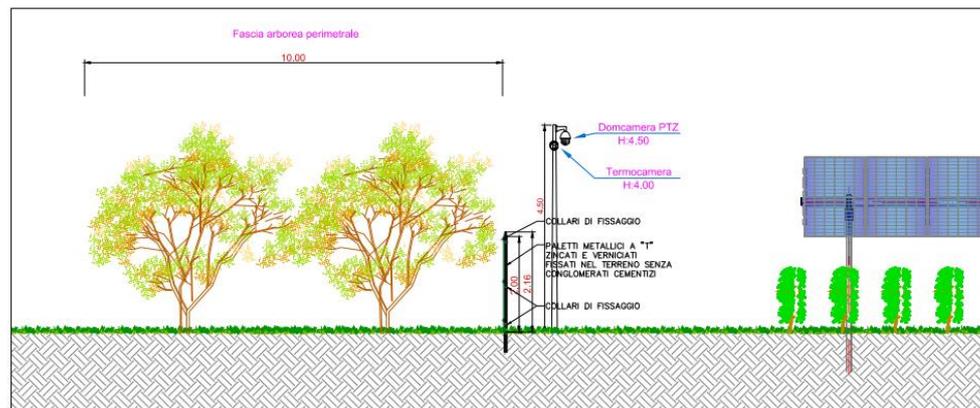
Sezione fascia arborea perimetrale esterna alla recinzione
